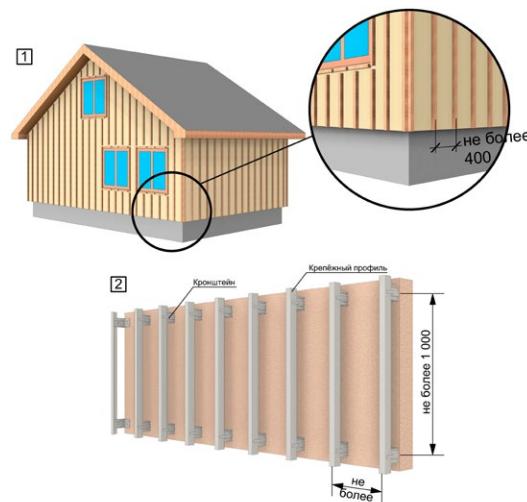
Вертикальная деревянная и металлическая обрешётка под горизонтальный сайдинг Döcke.
